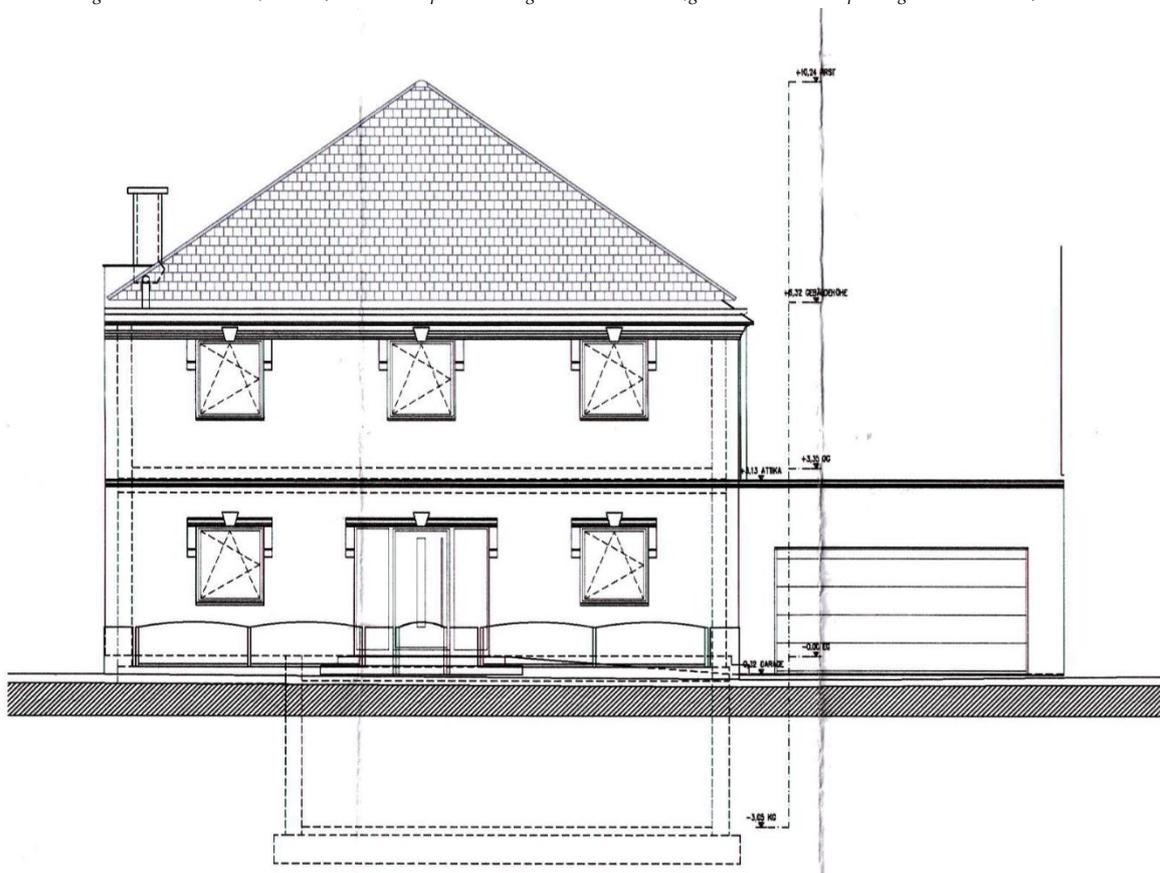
Ansicht West (Straße) | Einreichplan | Pongratz Bau GmbH (gezeichnet von Dipl.-Ing. Gassenbauer) | 01.04.2010
